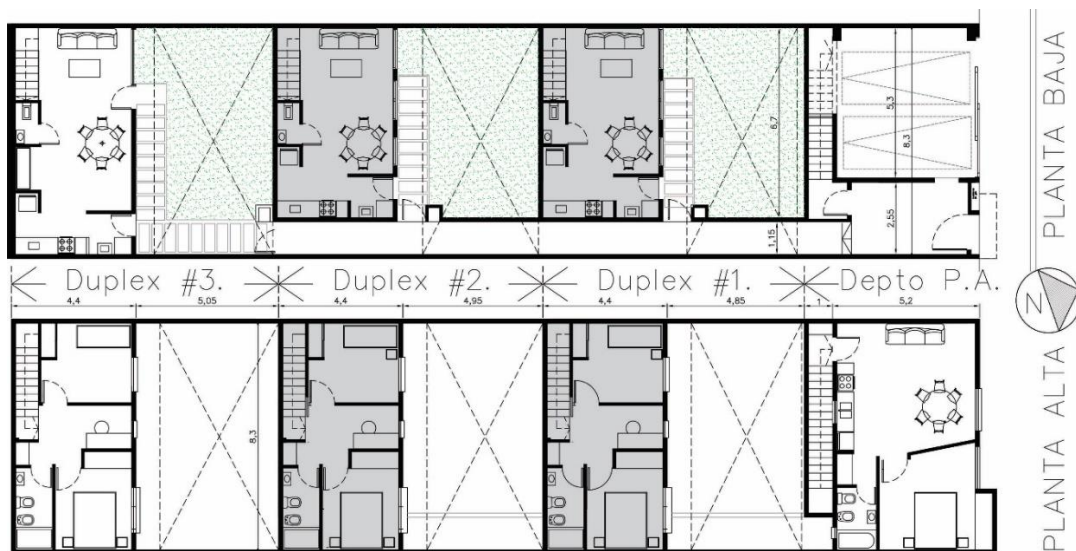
Planta baja y planta alta del PH. Las casas gemelas corresponden a los Dúplex #1 y Dúplex #2. Fuente: elaboración propia.
